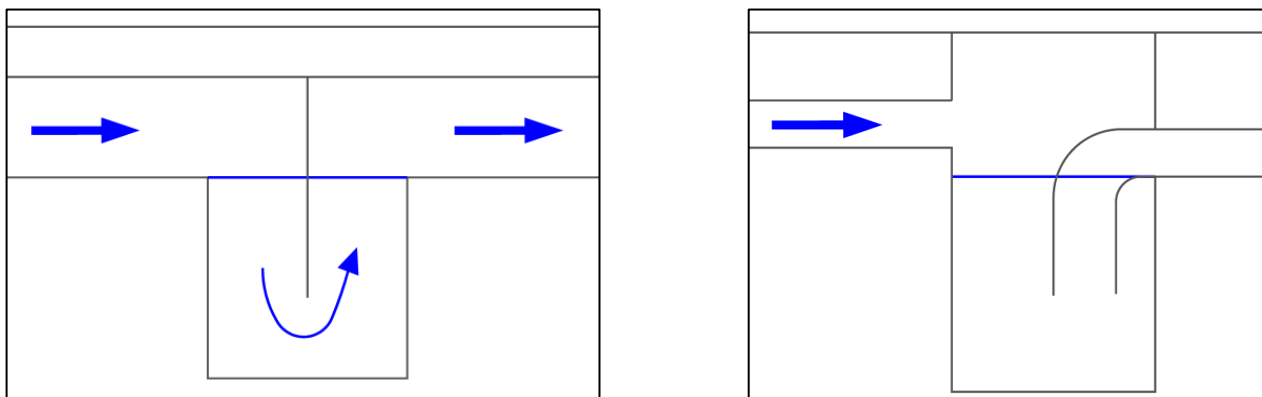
Schémas de principe de 2 exemples de zones de décantation (cloison siphonide et coude PVC)
